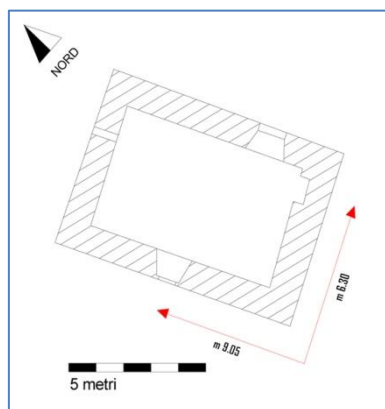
Planimetria della casa-torre del castello, CF 3.
